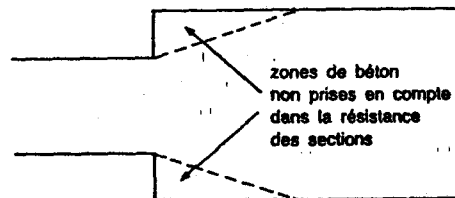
Poutre d'épaisseur ou de hauteur variable
